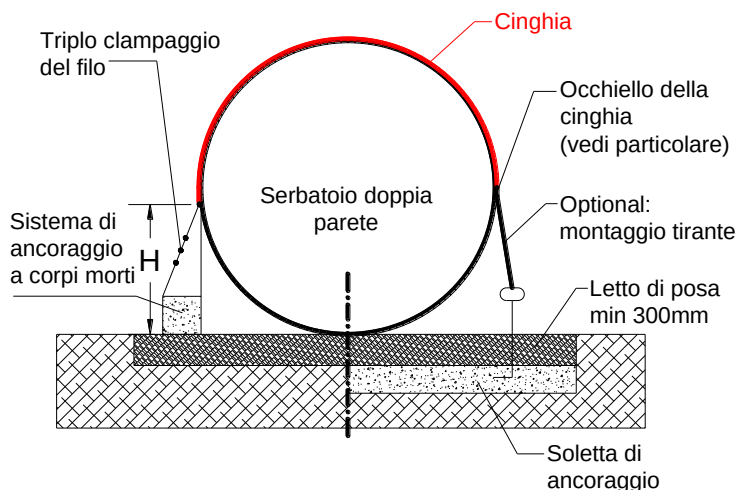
DISPOSIZIONE DELLE CINGHIE DI ANCORAGGIO
